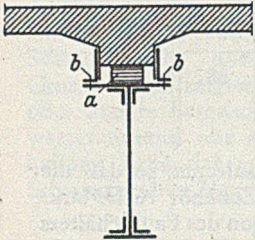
a) Rollen. b) Verkoppelung durch Nieten oder Schweißung.
